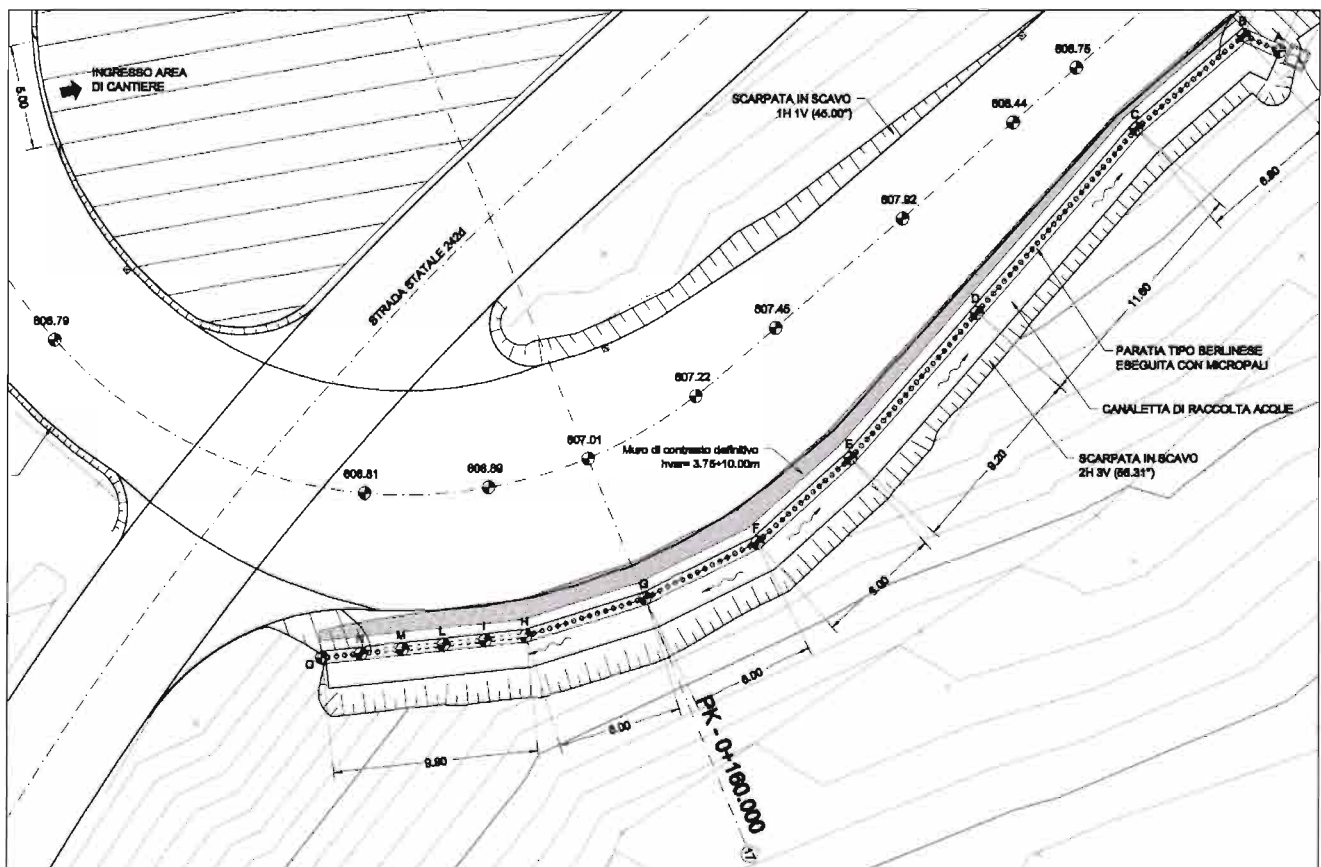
Ubicazione planimetrica della sezione di verifica.
